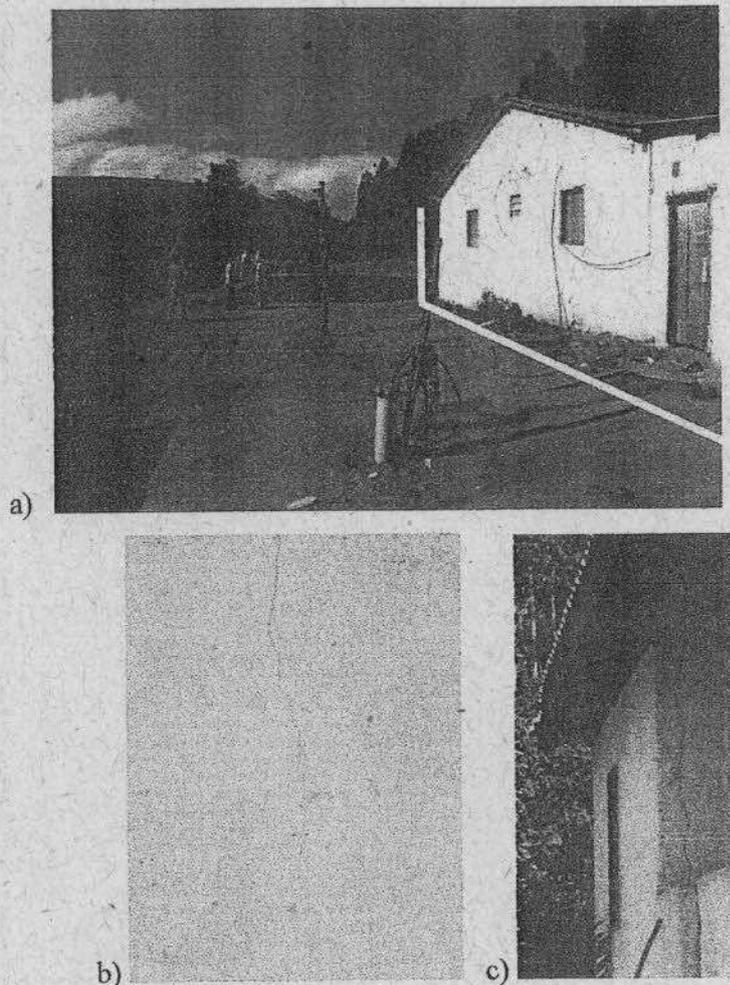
a) Linha branca representa a faixa de Servidão, observa-se que ela distancia-se menos de 5 metros da casa do parceiro, ao fundo observa-se o cafezal. b,c) Destaque para as rachaduras que a casa já apresenta.
